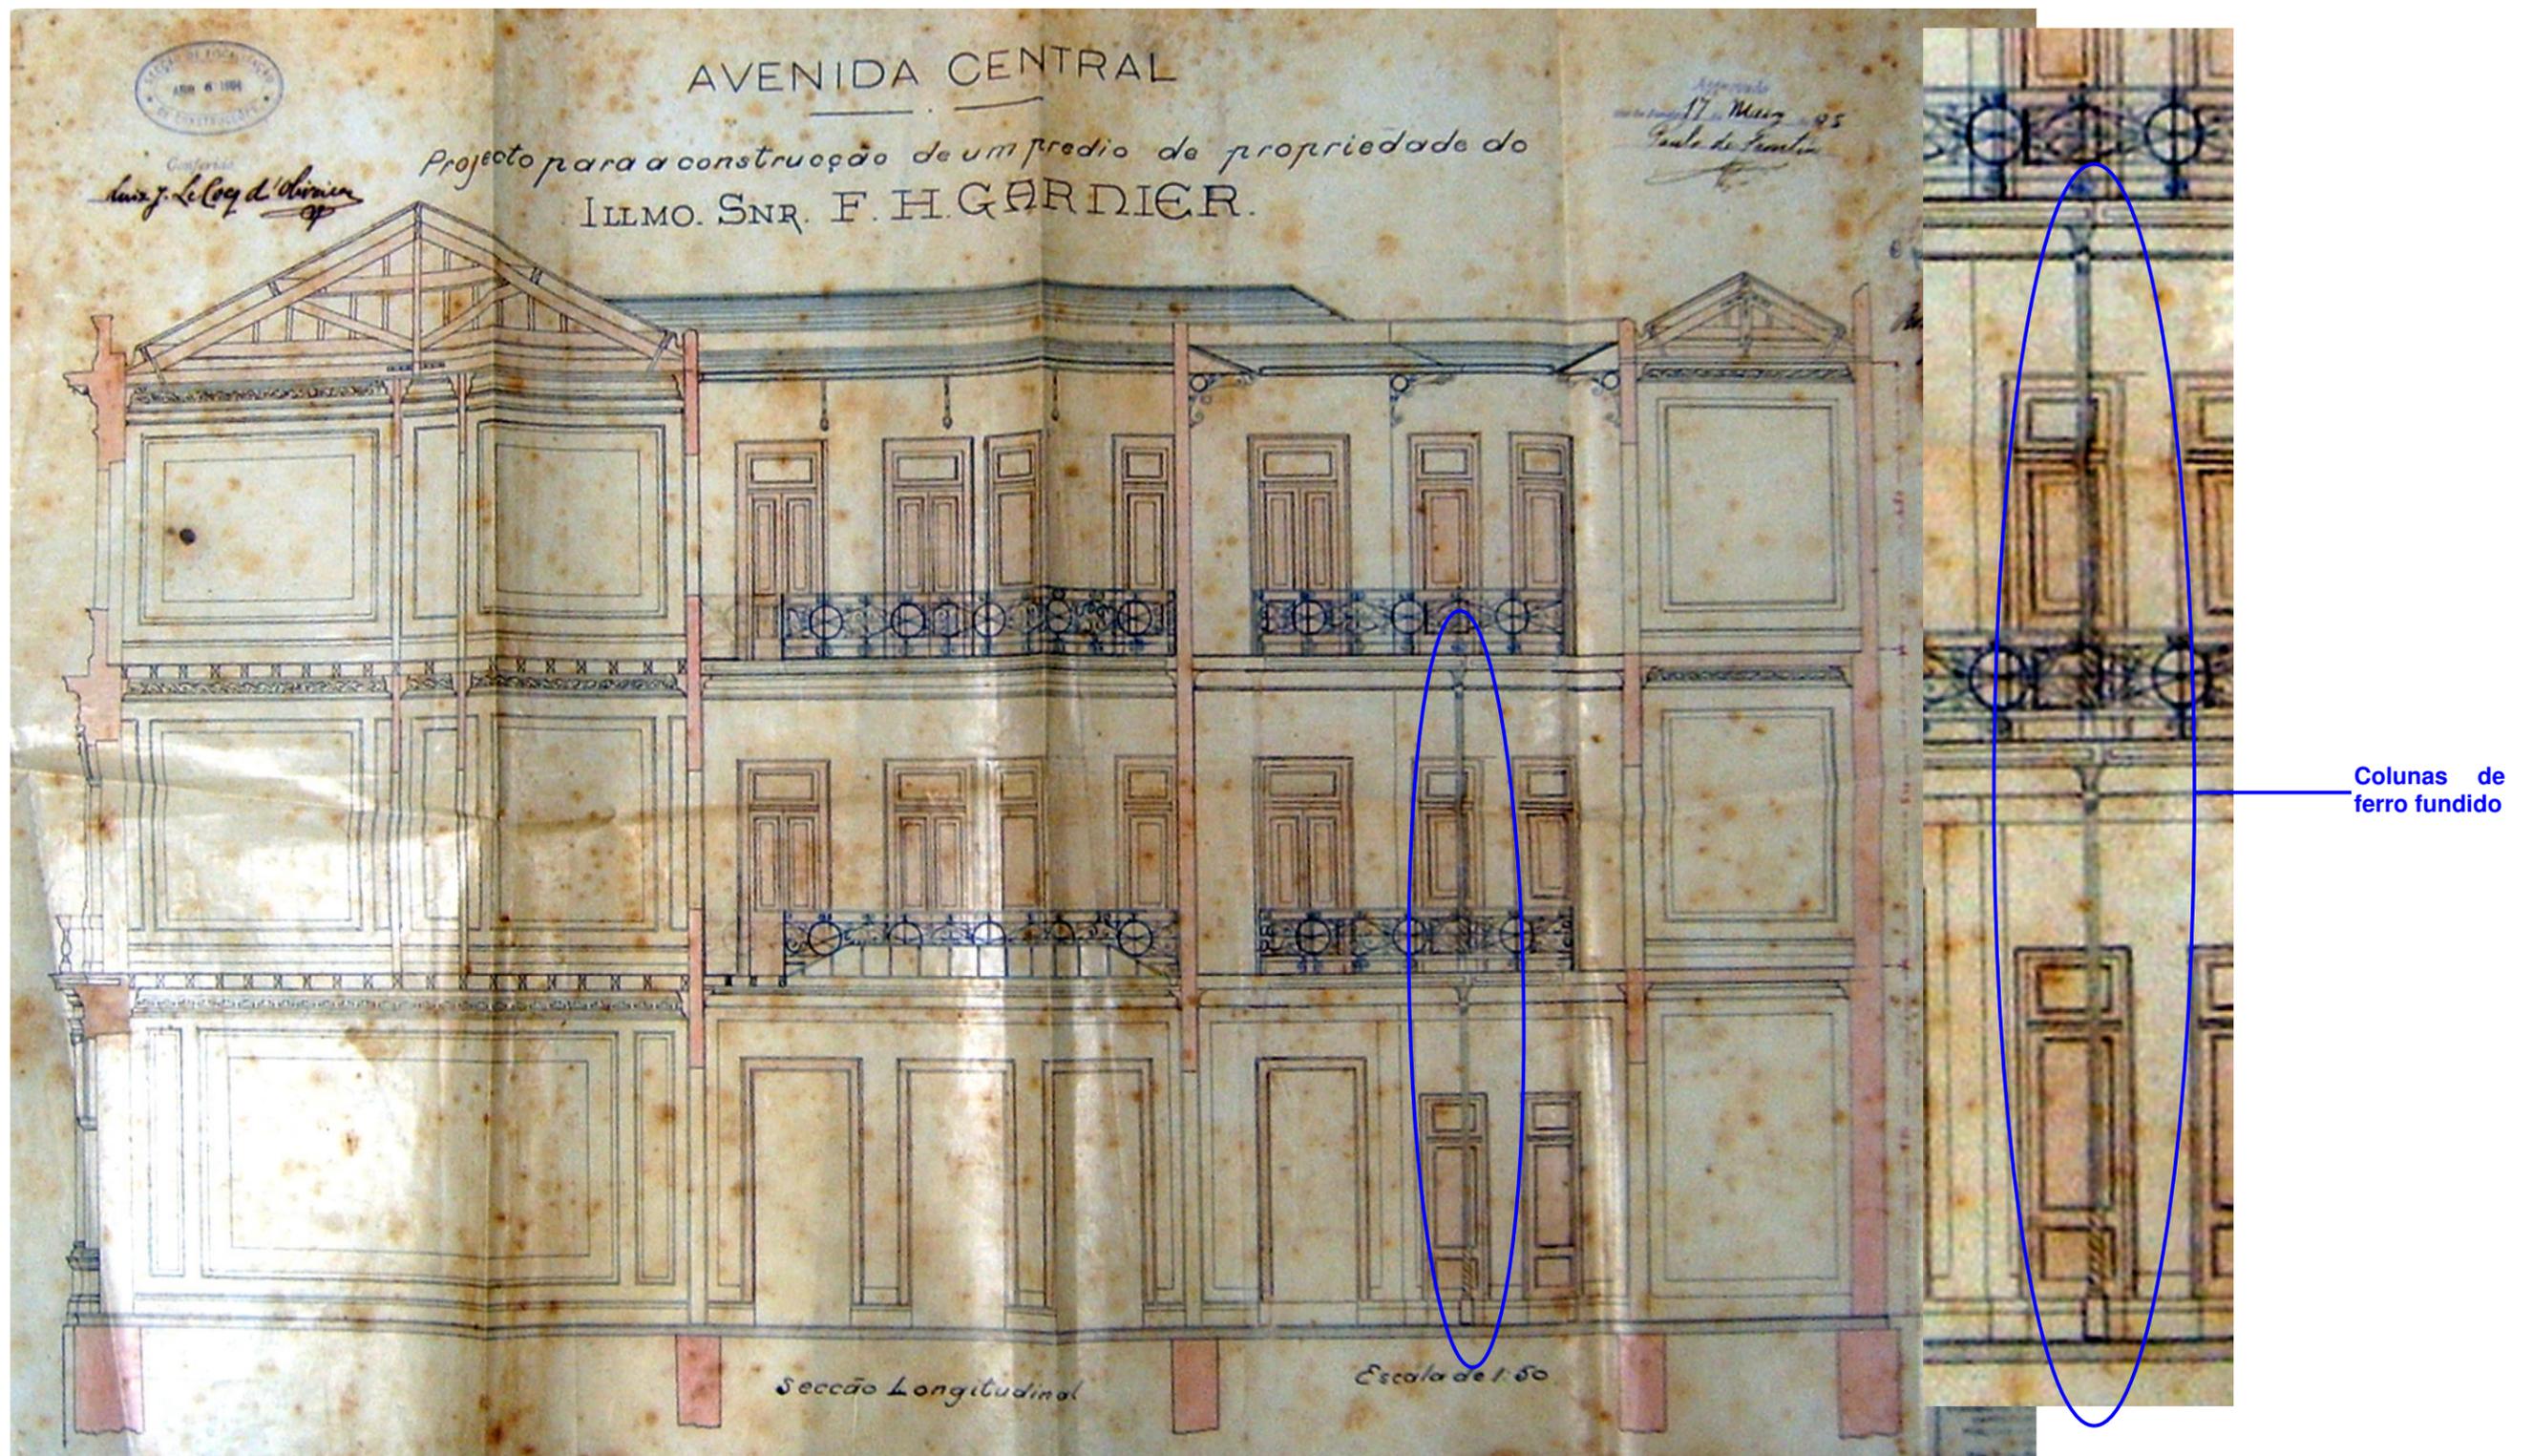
Corte longitudinal do nº. 247 (Arquivo Nacional). Podemos notar as colunas de ferro fundido no Terezo e 2º pavimento, além de outros elementos metálicos, como guarda-corpos, mãos francesas e clarabóias.
